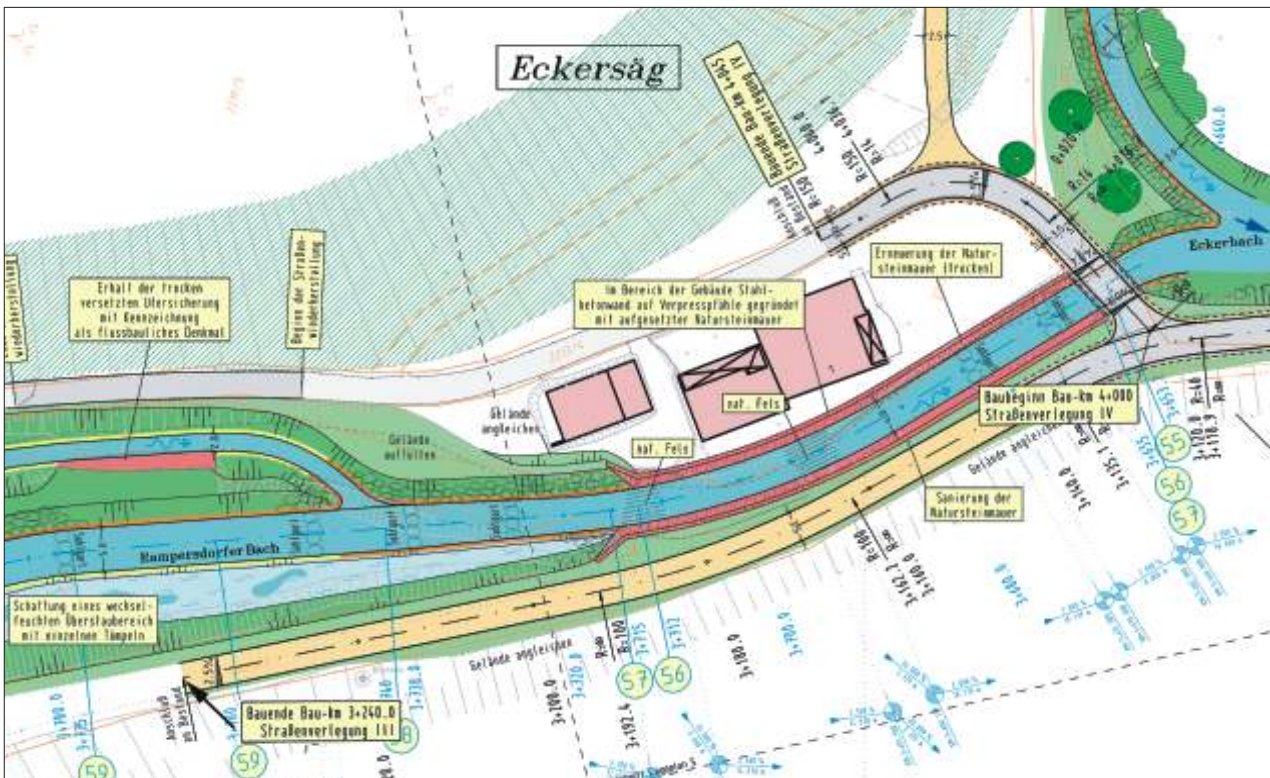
Bachverlegung mit Anbindung des bestehenden Bachbettes
